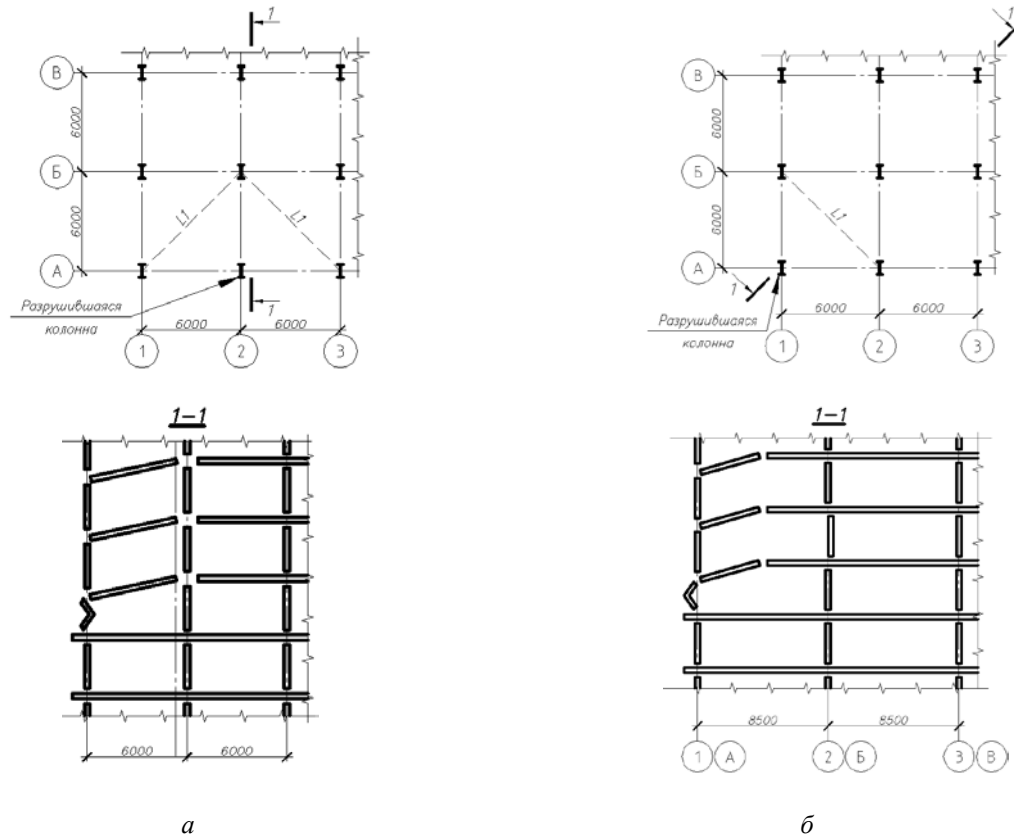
Схемы возможных обрушений перекрытий при разрушении колонн IV и V групп
